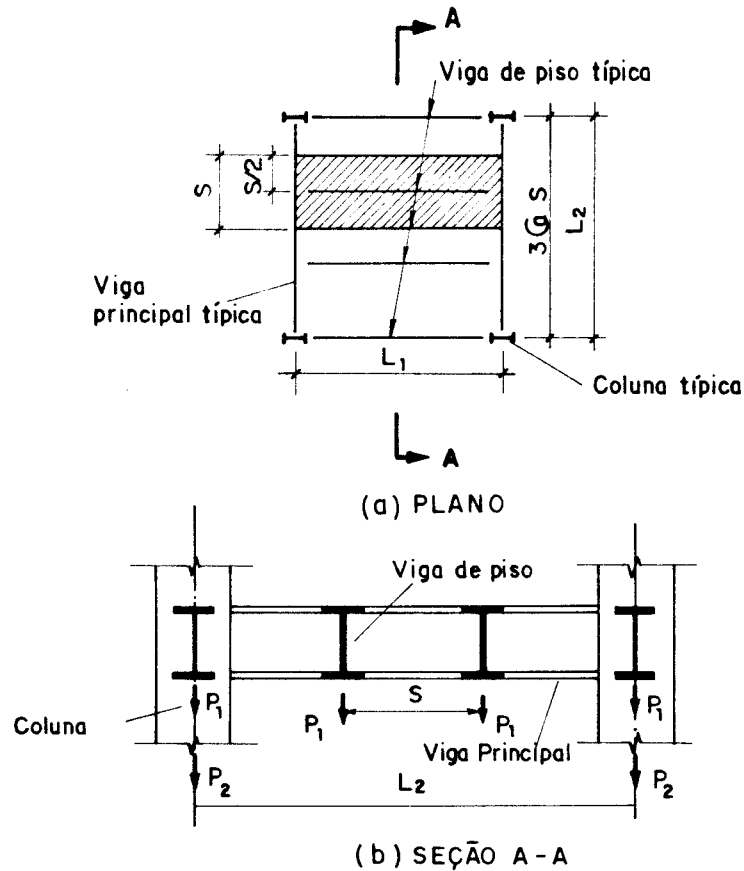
Vigamento plano de aço mostrando a distribuição das ações vivas [95]
